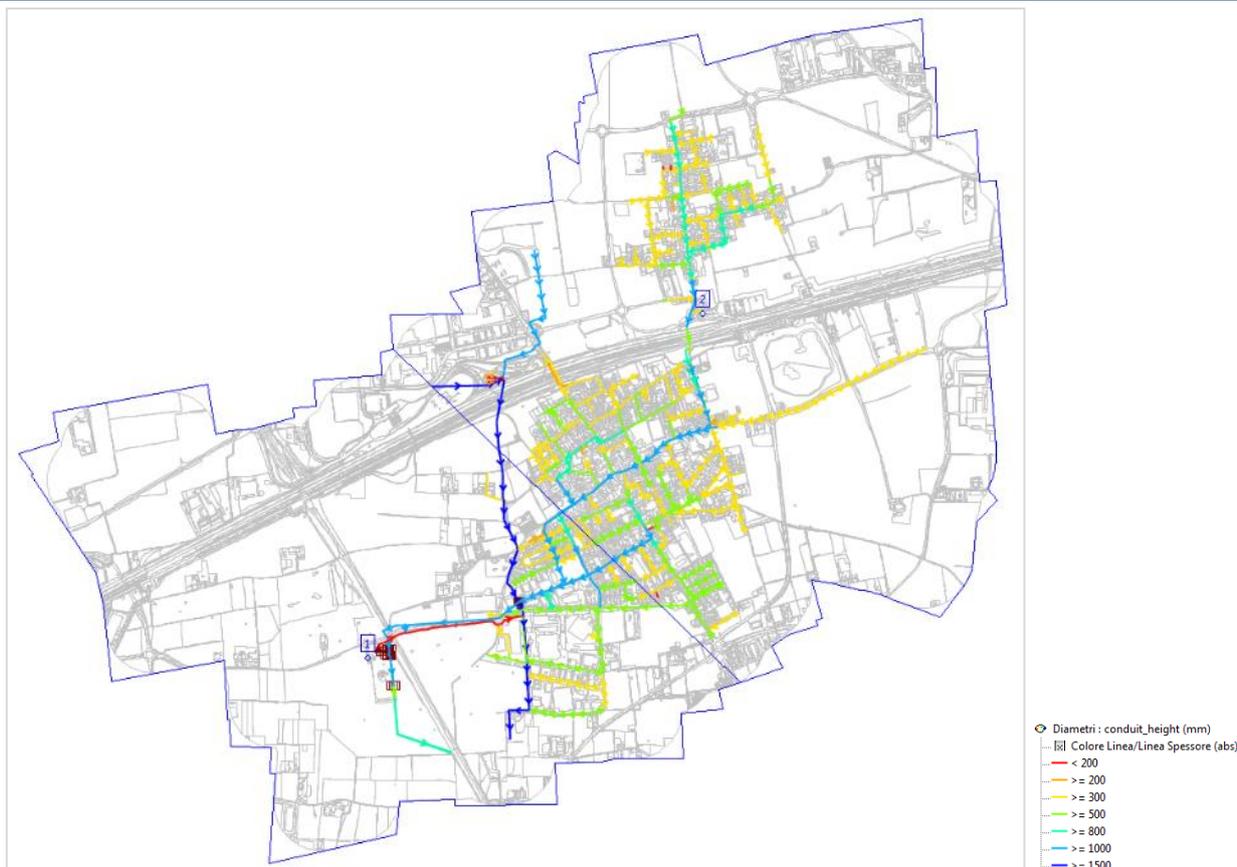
Planimetria della rete fognaria con indicazione delle classi di diametro delle tubazioni
